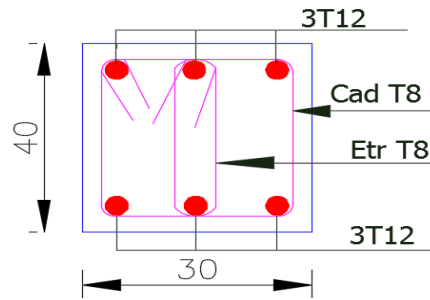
Exemple de ferrailage des Poutres PP et PS du RDC
